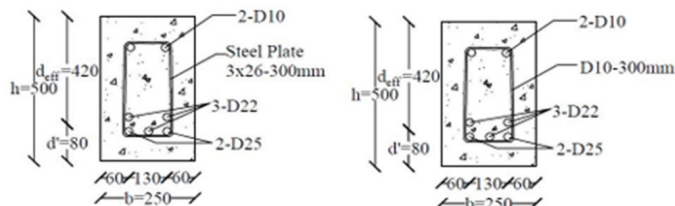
Detail pemasangan *steel plate strip* sebagai tulangan geser (Eklou et al. 2021)
